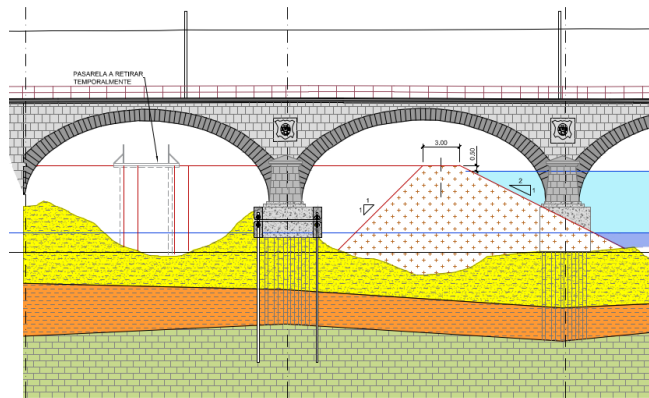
Ataguía de tierra para ejecución de refuerzo en pila 1.
